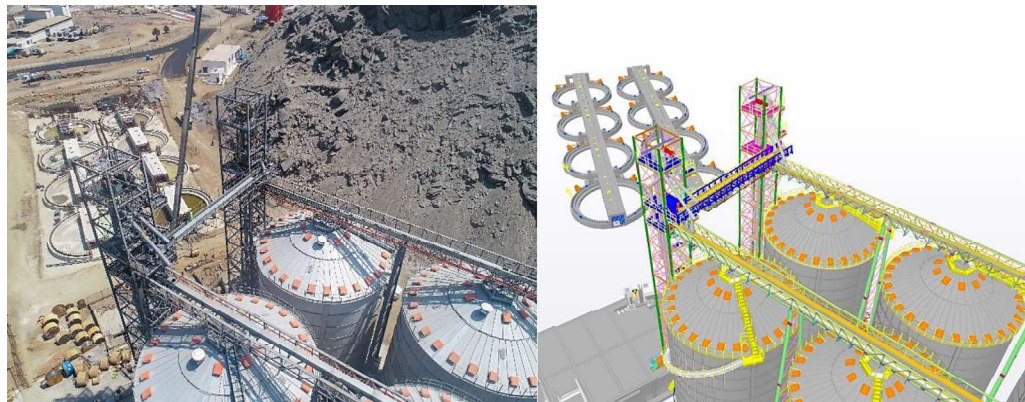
Montaje de estructuras metálicas e instrumentación. Elaboración propia-CRT
